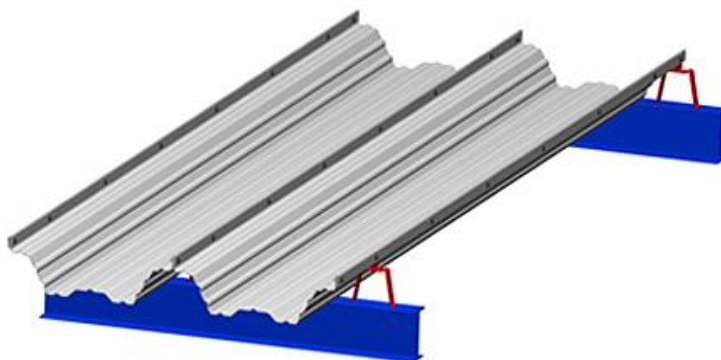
Perfil de aço corrugado conforme sistema de telhamento ortotrópico
